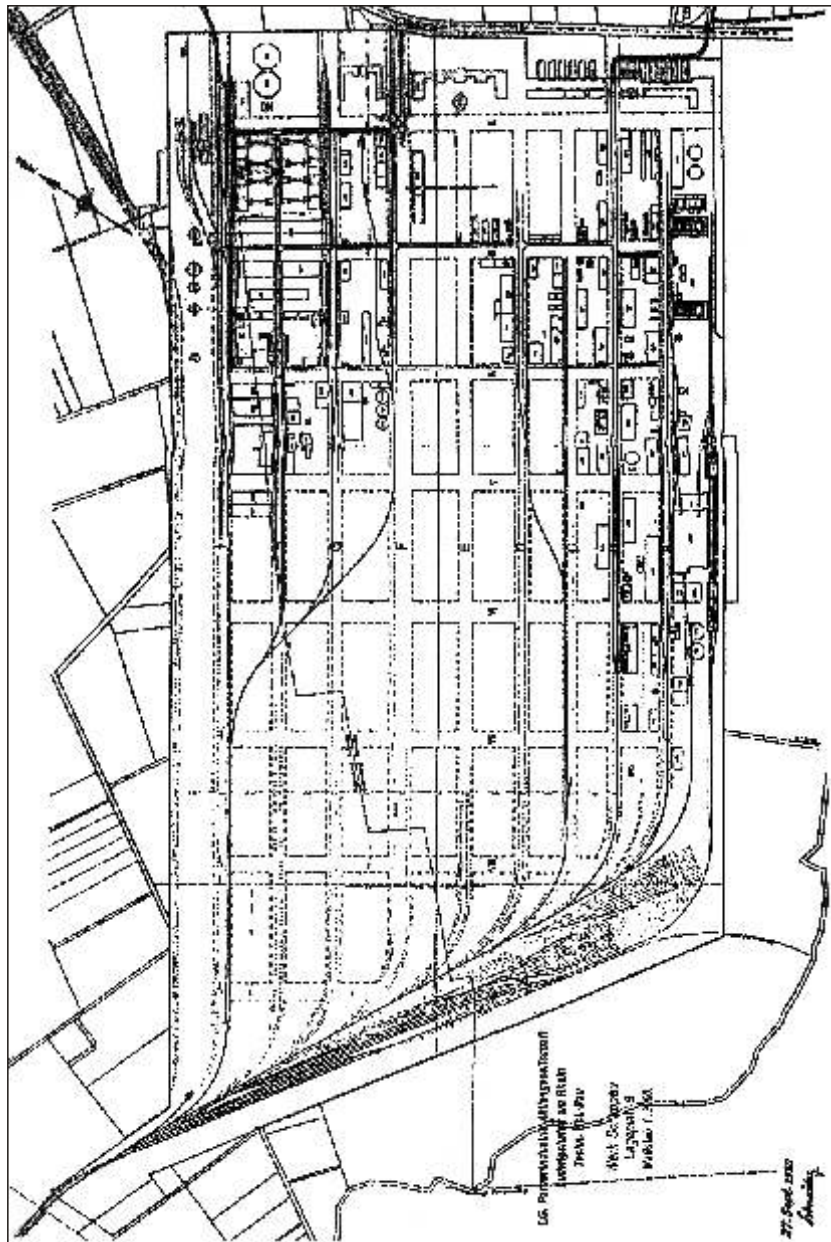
Lageplan Nr. 9 vom 27.09.1936
